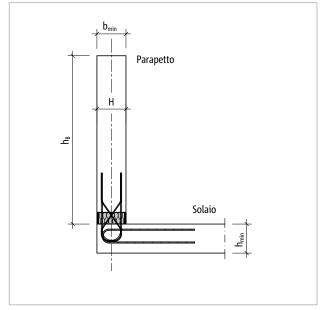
Schöck Isokorb® T tipo AP: sistema statico con altezza del parapetto h_B ; altezza H Isokorb®
